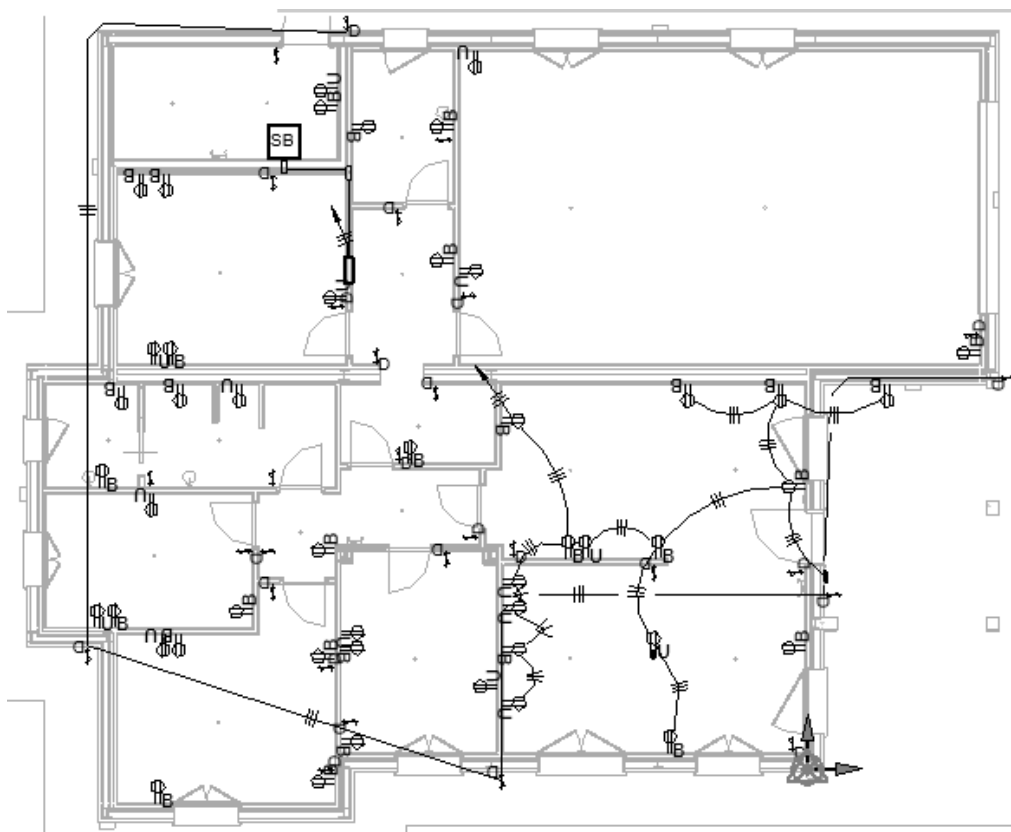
vista di pianta Revit impianto elettrico abitazione
